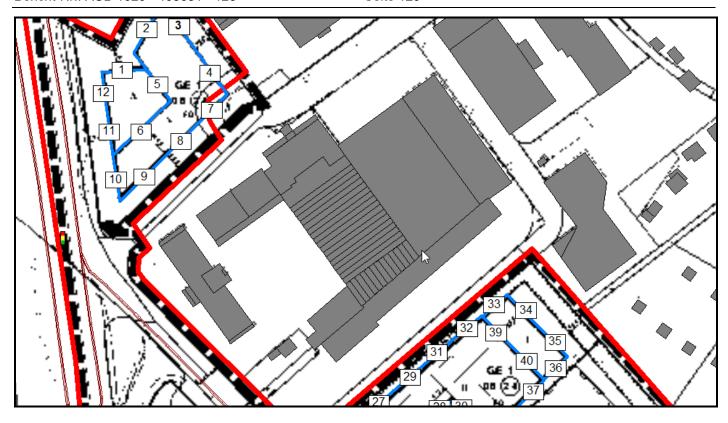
Lage und Nummerierung der Fassadenanschnitte
